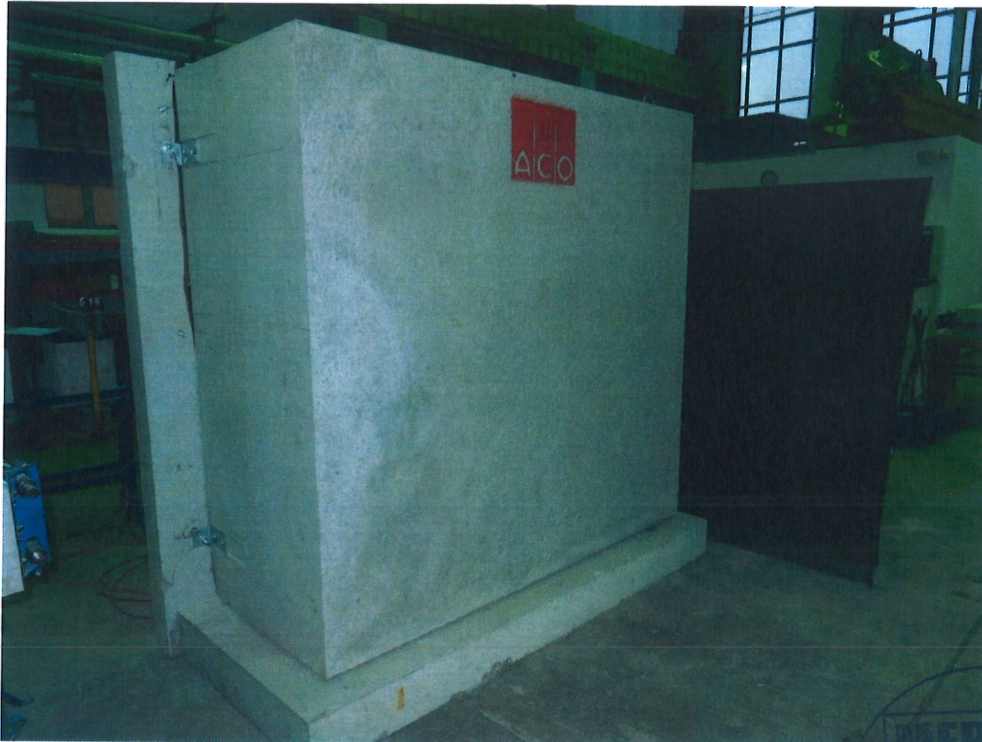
für die Dichtigkeitsprüfung über dem ACO Betonlichtschacht mit 100 mm Dämmung montierter Beton-Großlichtschacht
